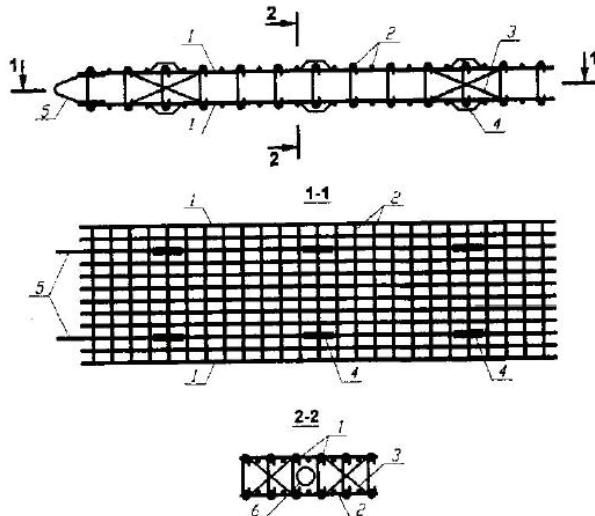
Схема арматурного каркаса «стены в грунте»: 1 – стержни рабочей арматуры; 2 – стержни распределительной арматуры; 3 – диагональные связи; 4 – направляющие элементы; 5 – монтажные элементы; 6 – места установки бетонолитной трубы
